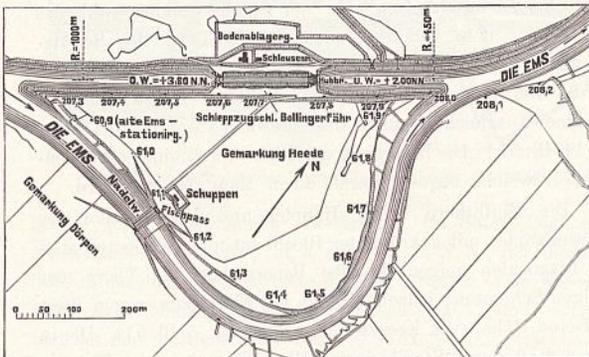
Lageplan der Schleusen- und Wehranlage bei Bollingerfähr.
